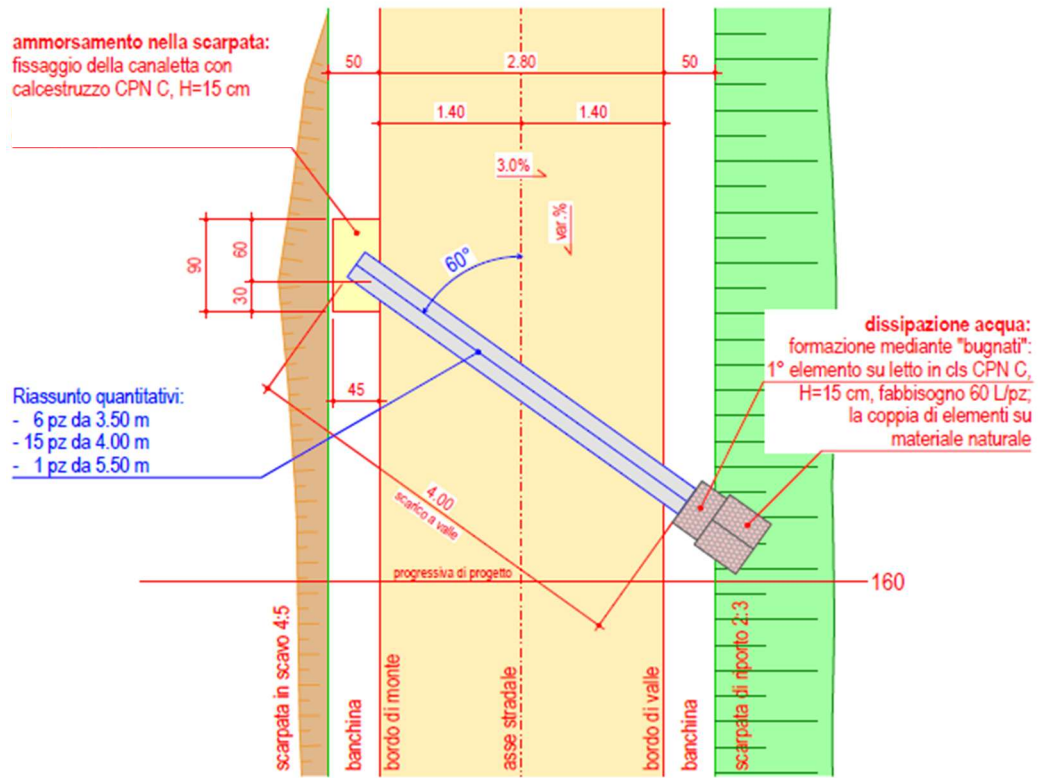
Pianta nuove canalette (su pavimentazione in asfalto)
